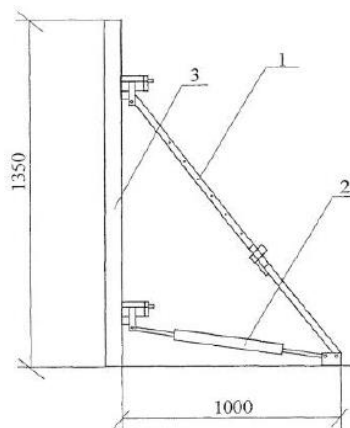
Устройство подкосов опалубки: 1 - консольная подпорка с соединительным шарниром, крепящимся фланцевым болтом к функциональной распорке; 2 - функциональная распорка; 3 – щит опалубки.
